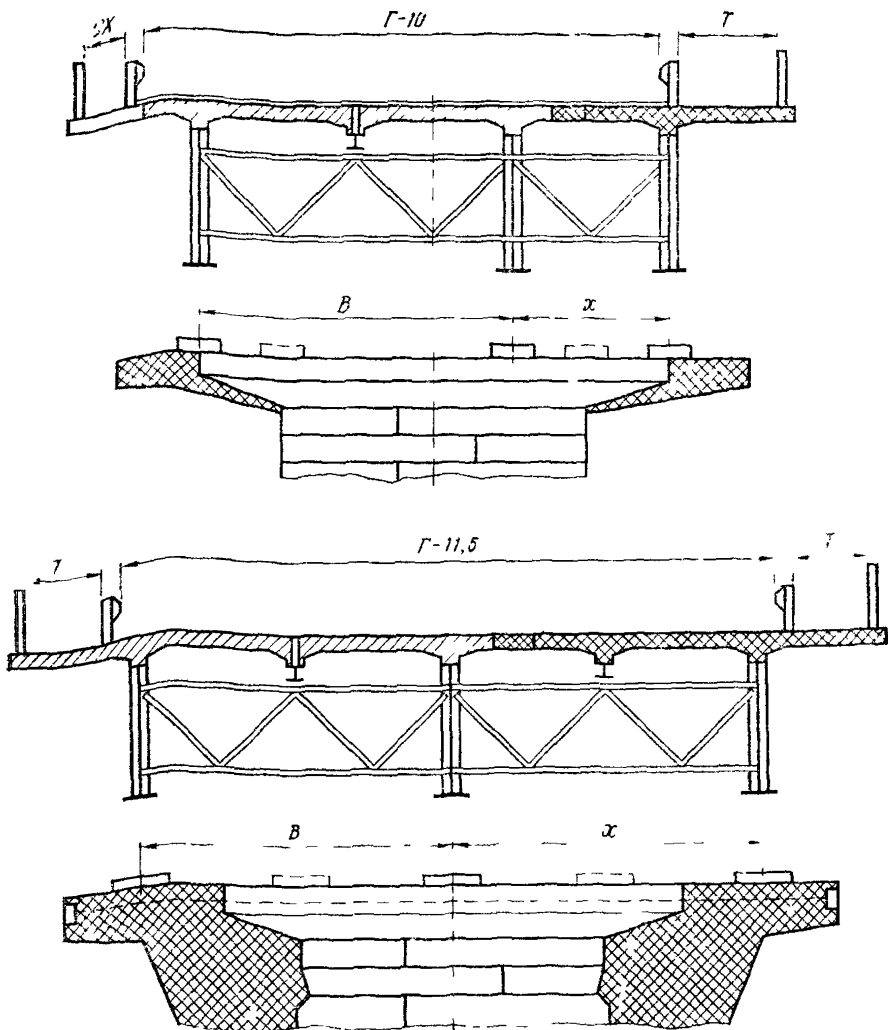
Схемы уширения сталежелезобетонных пролетных строений добавлением новых балок
